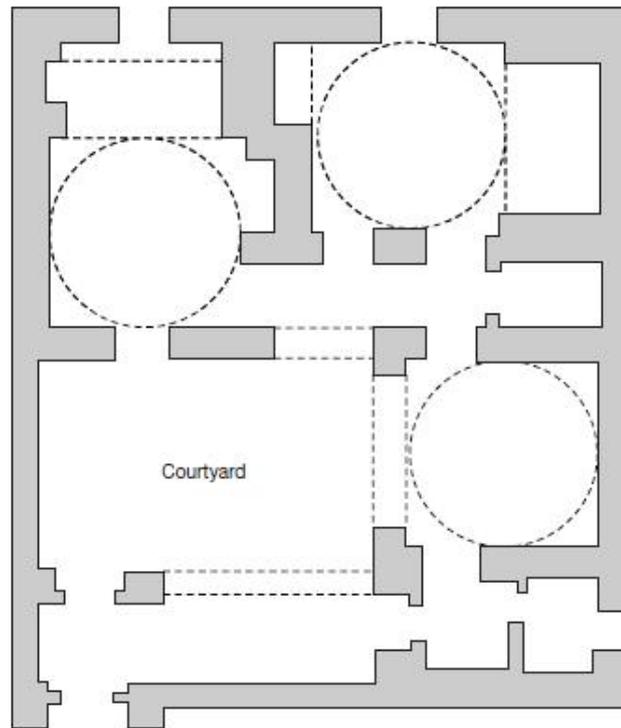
Plan d'une maison à patio construite par Fathy (Source: Mortada 2003)
